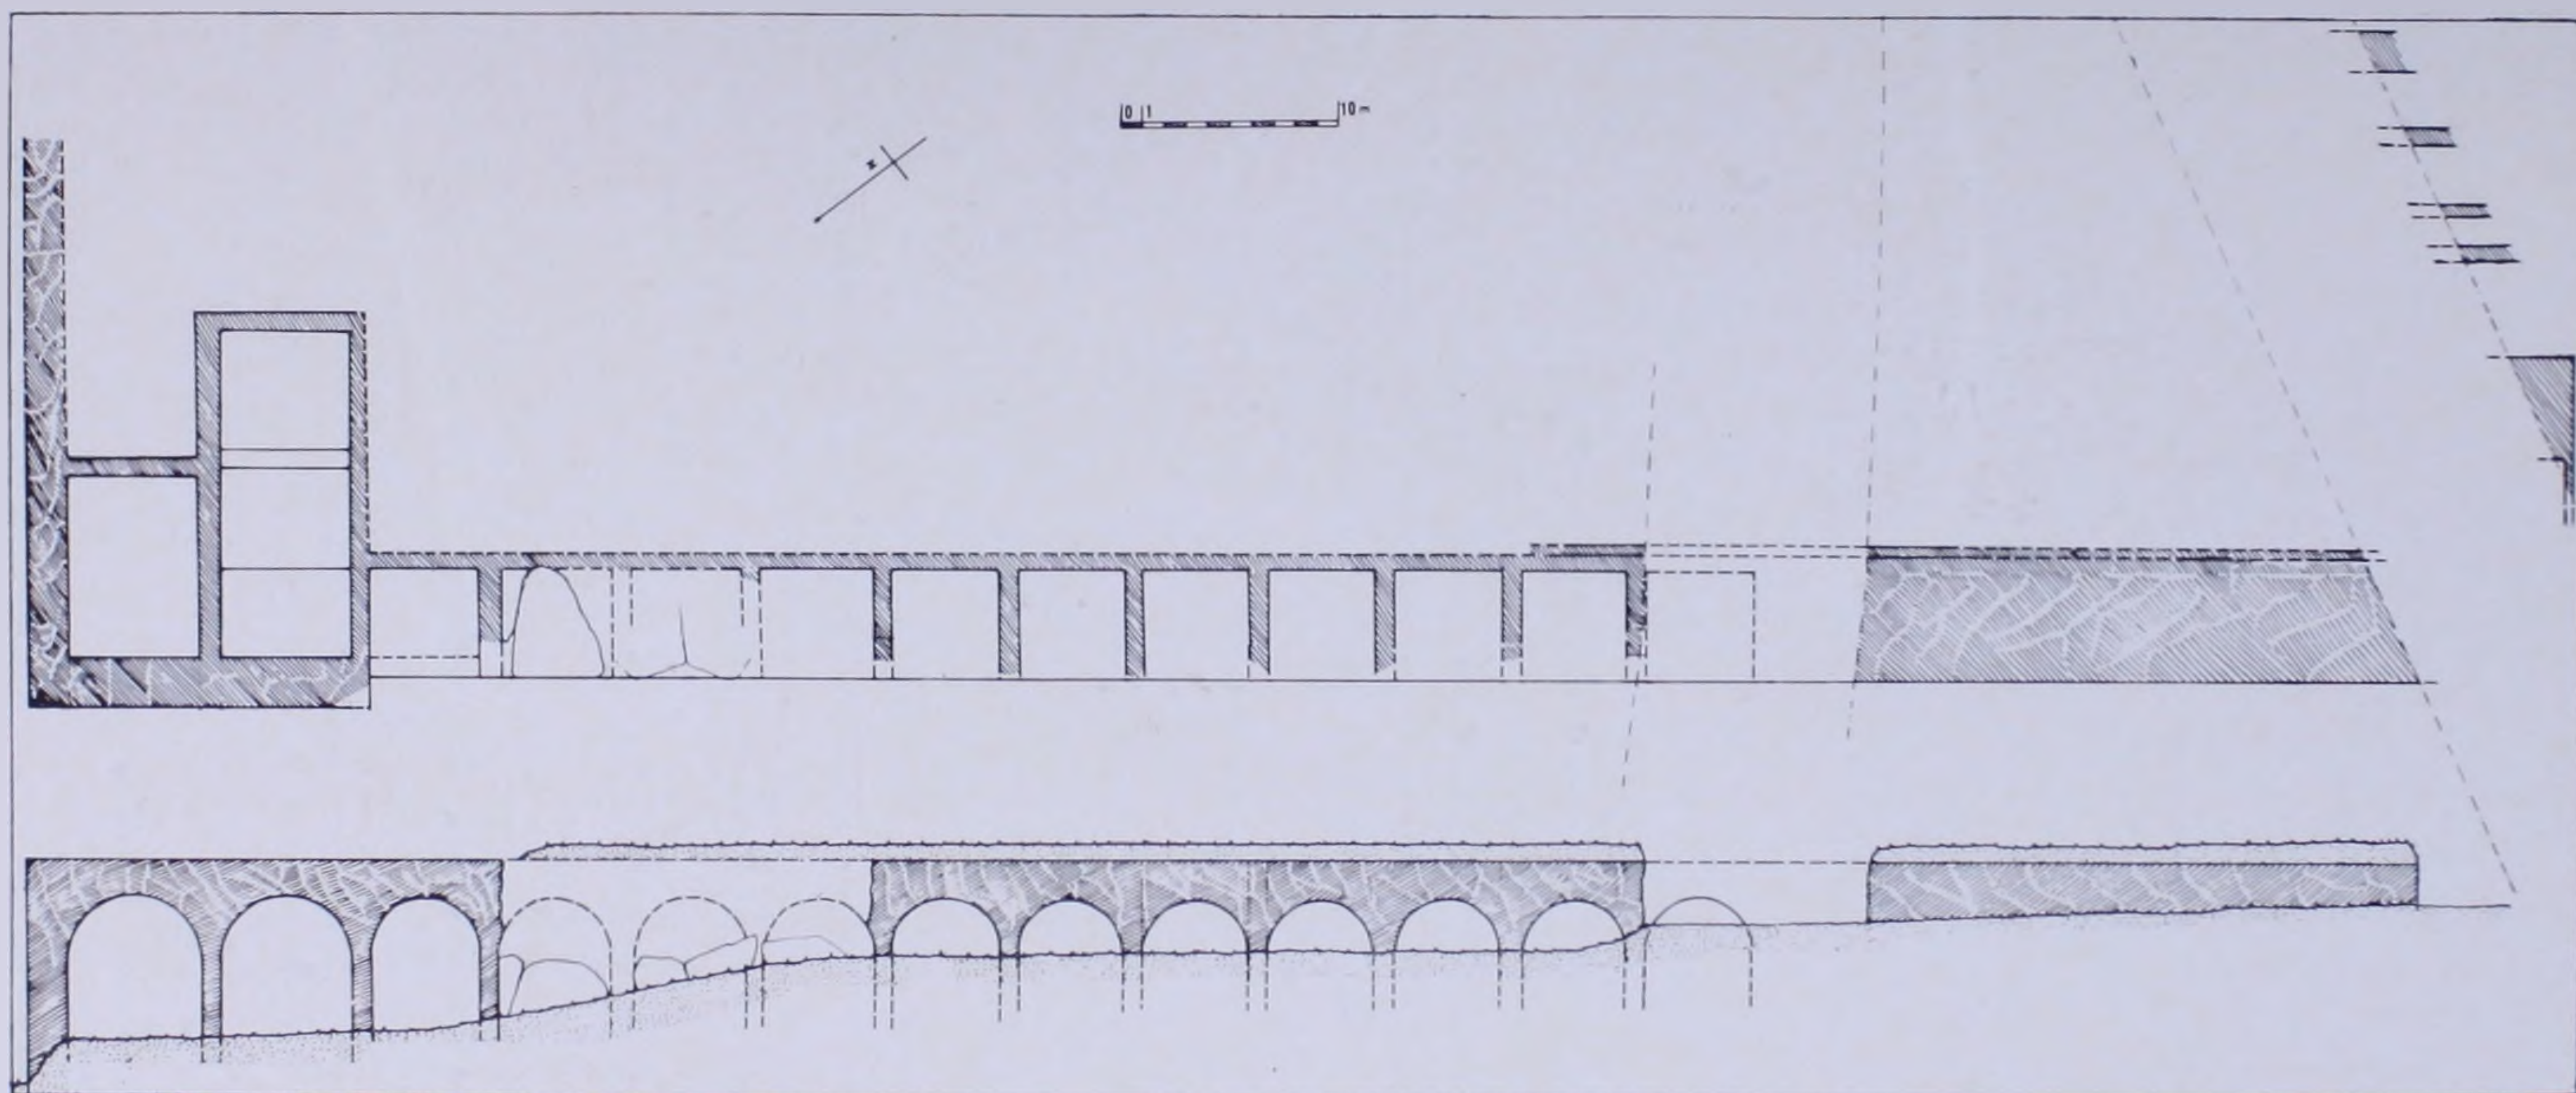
Villa detta di Opimiano, pianta ed alzato del terrazzamento inferiore sul lato NO.
